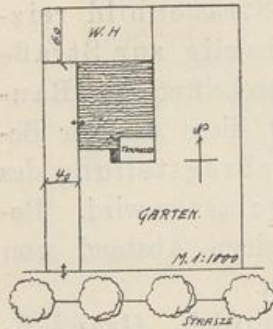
Straße im Südendes Grundstücks. Haus 6,0 m von der hinteren Nachbargrenze mit 4,0 m Seitenbauwich an der Westseite, ermöglicht die beste Orientierung von Haus, Wirtschaftshof und Garten.
